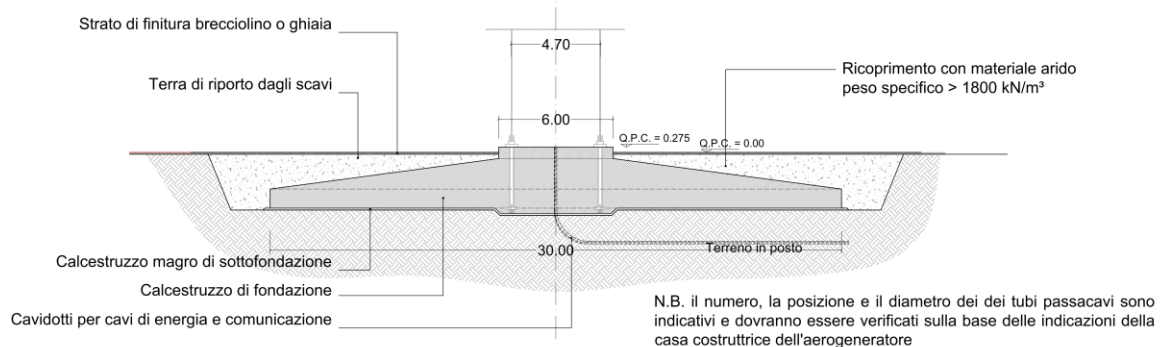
Pianta e vista della fondazione tipo dell'aerogeneratore
